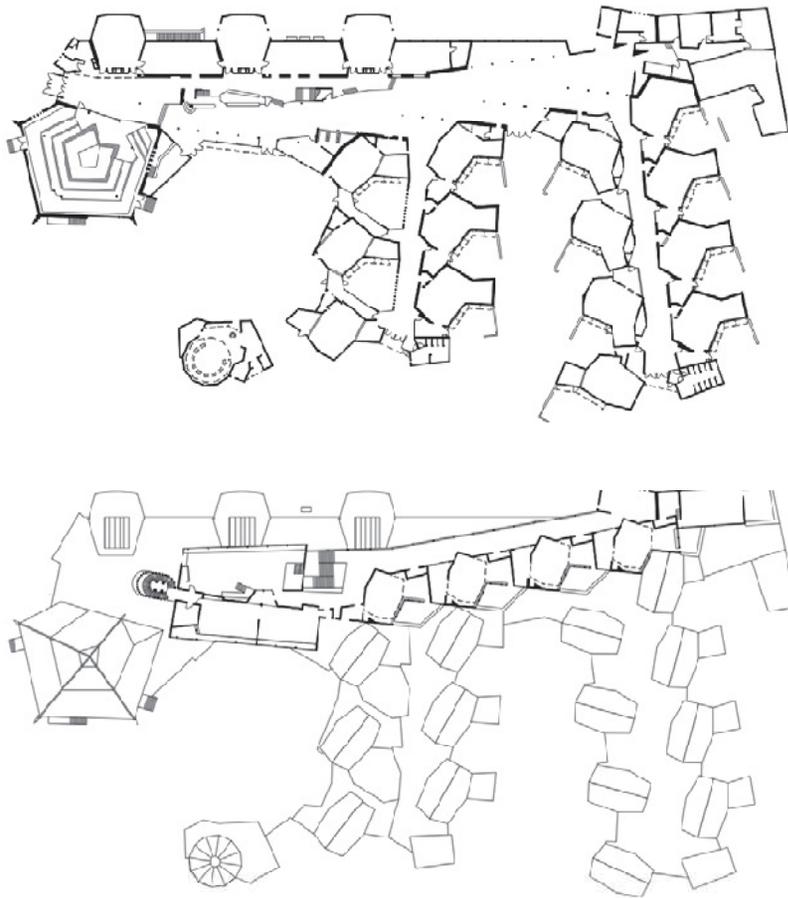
Planta baja y Planta alta del Colegio Geschwister-Scholl en Lünen, de Hans Scharoun. Fuente: Universidad de Sevilla. (2017). Arquitectura Escolar y Educación. PPA N° 17.
